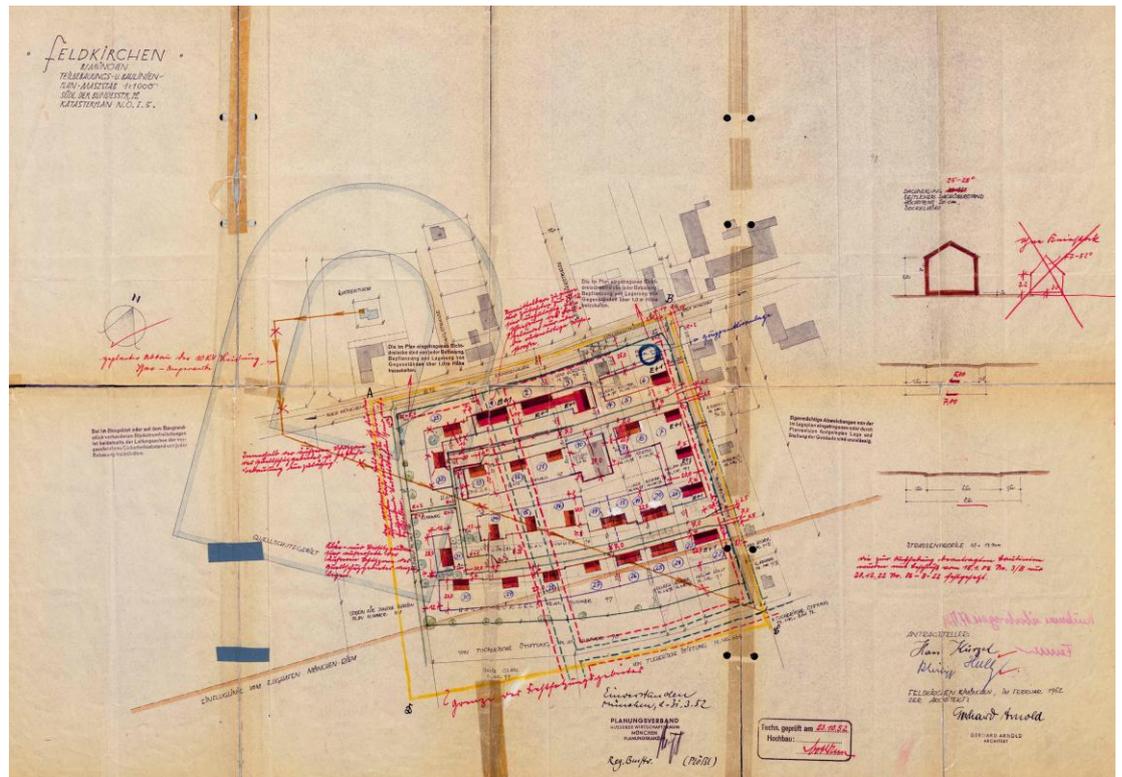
Ausschnitt aus dem Baulinien- und Bebauungsplan Nr. 32, rechtskräftig seit 25.06.1957
